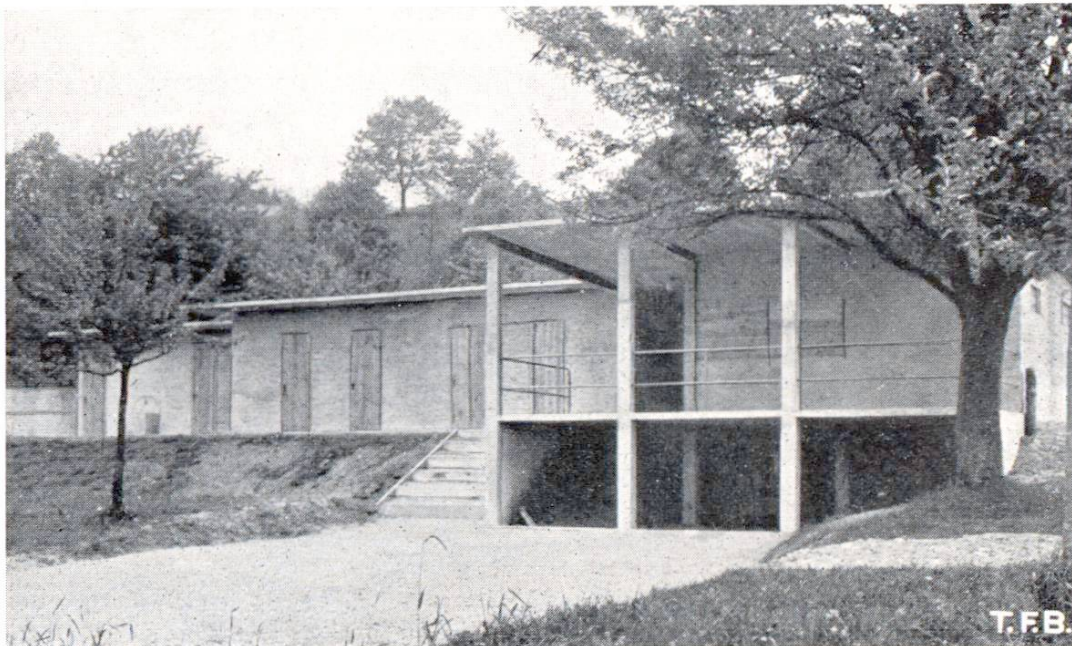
Die Hochbauten des Strandbades Tennwil (Hallwilersee) aus Cement-Streckmetall und Eisenbeton
